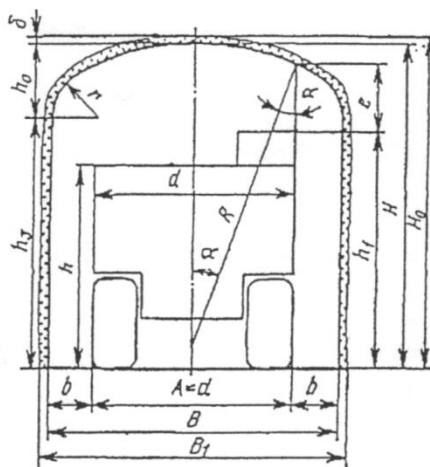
Сечение подэтажной выработки прямоугольно-сводчатой формы при безрельсовом транспорте с набрызг-бетонной крепью.
